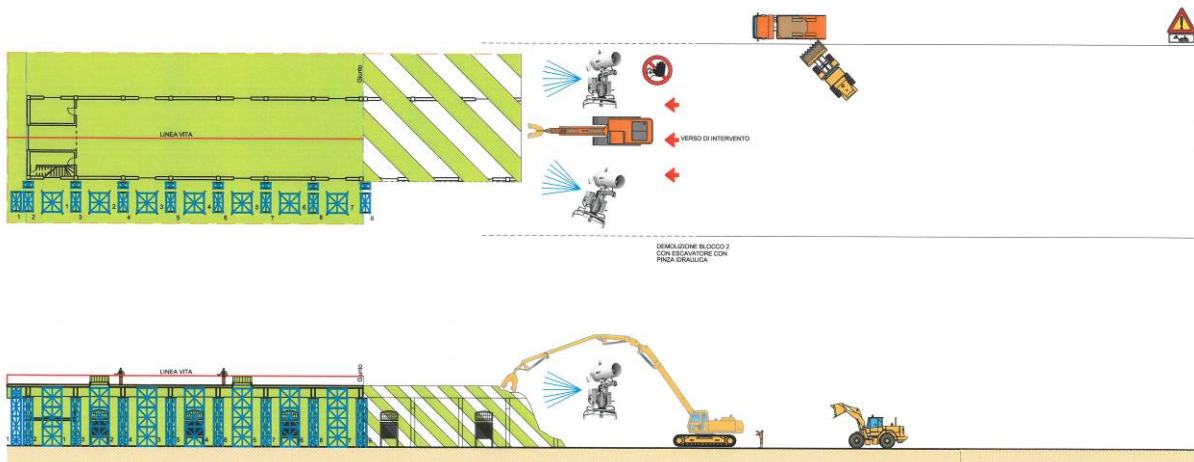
Planimetria e vista longitudinale Demolizione Edificio A9 – Demolizione con pinza idraulica
